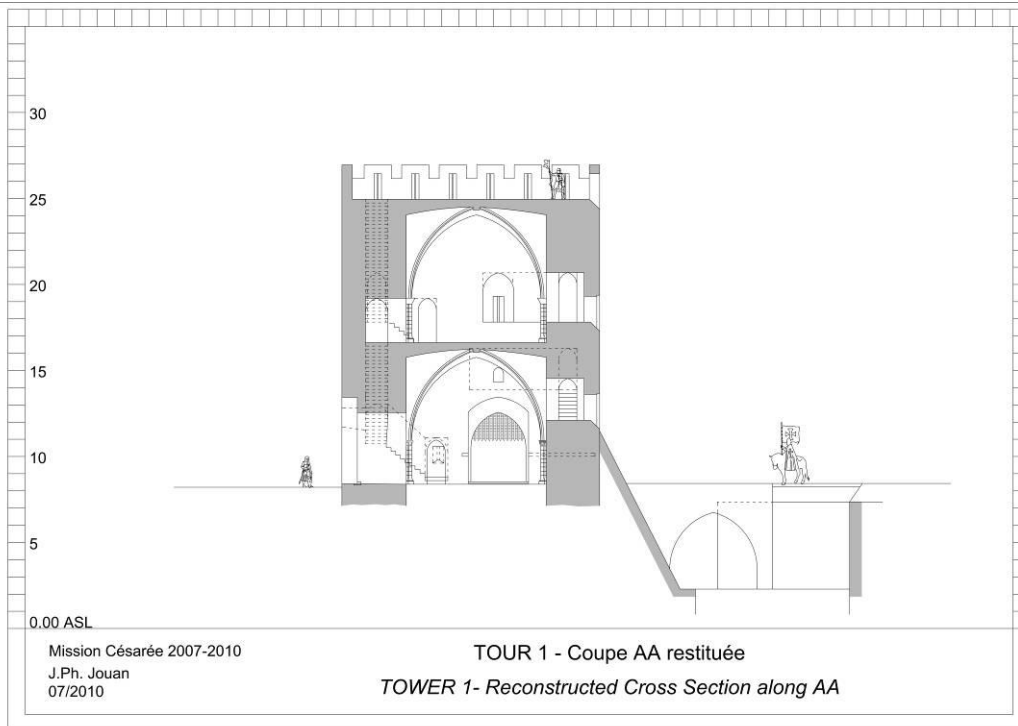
Tour 1. Coupe restituée Sud-Nord
